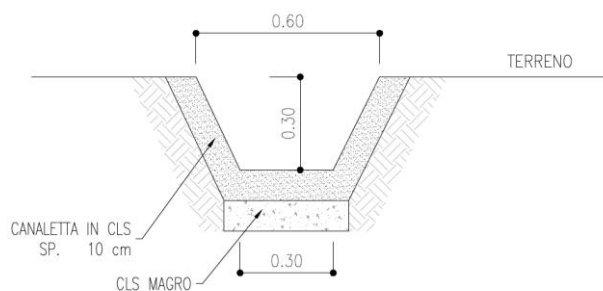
Tipologia di sezioni trapezie in calcestruzzo utilizzate – CANALETTA SU BANCA
